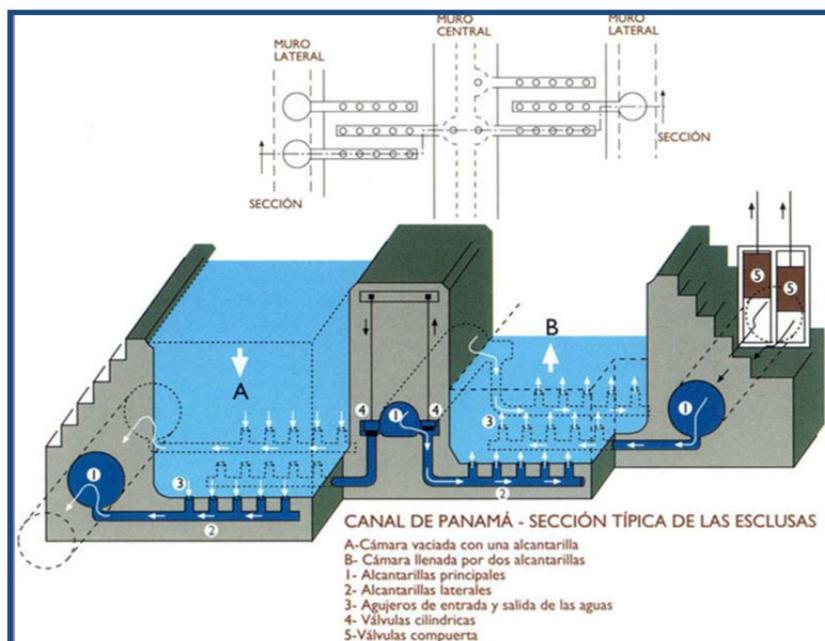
Sección Transversal de las Esclusas y alcantarillas
